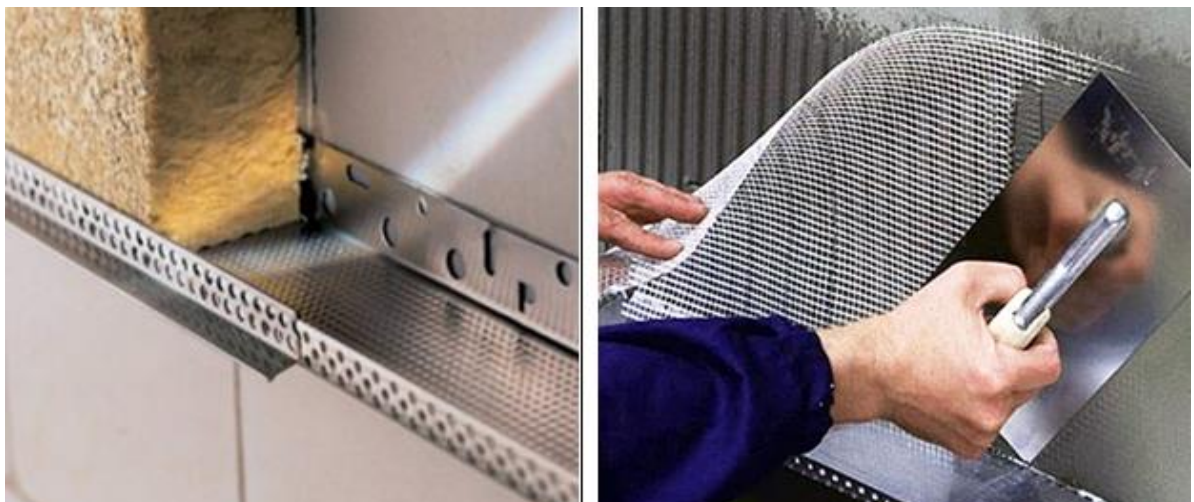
Фрагмен укладки базальтового утеплювача та армуючої сітки при утеплення фасаду будинку.
